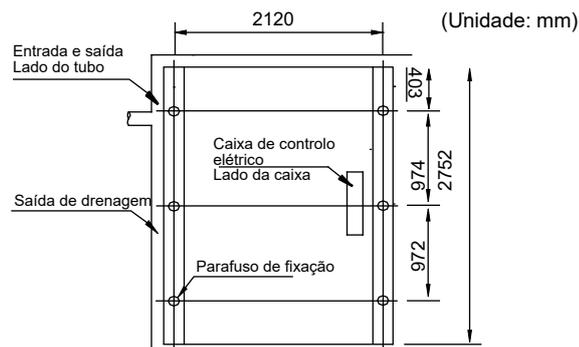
Vista superior do diagrama de dimensões de instalação de MUENR-180-H12T / MUENR-180-H12T(K)
